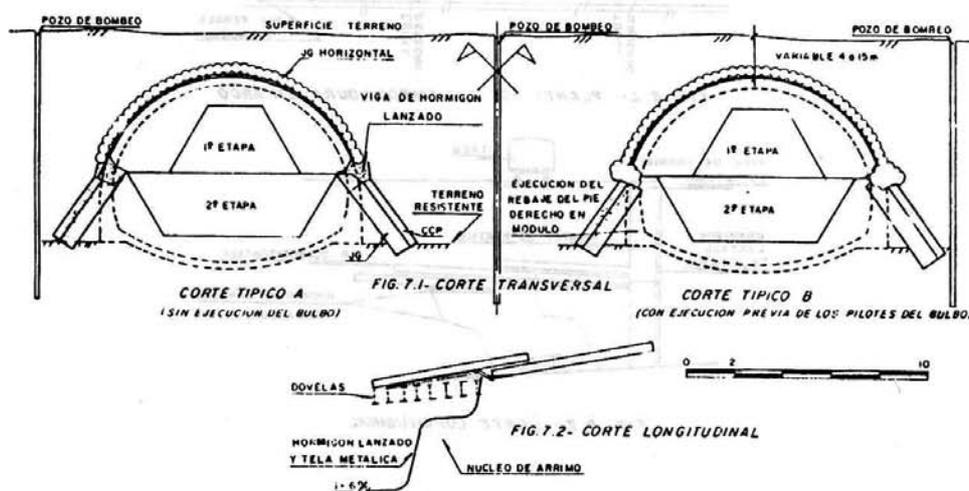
CONSOLIDACION CON "JET-GROUTING" A PARTIR DEL FRENTE DE EXCAVACION
